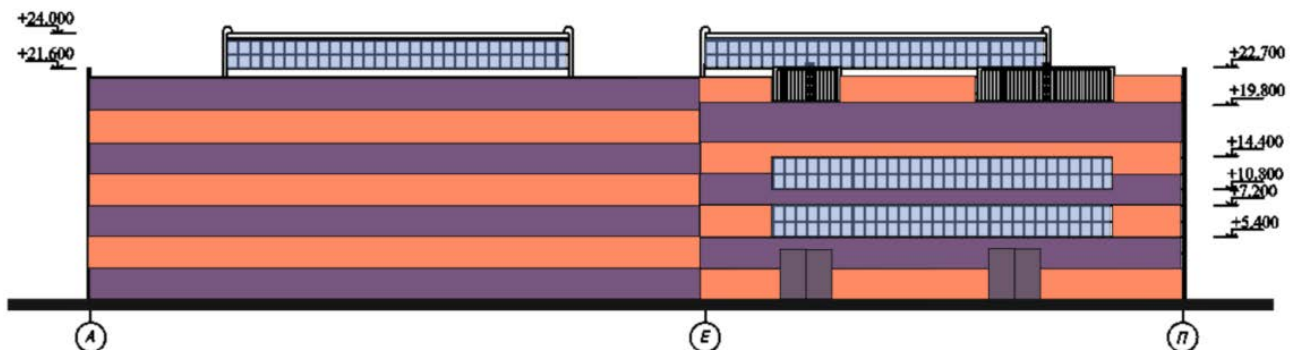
Схема розкладання стінових панелей фасаду А-П.
